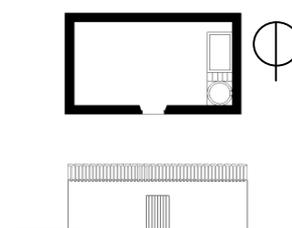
Planta e alçado nordeste do edifício do núcleo sul.
